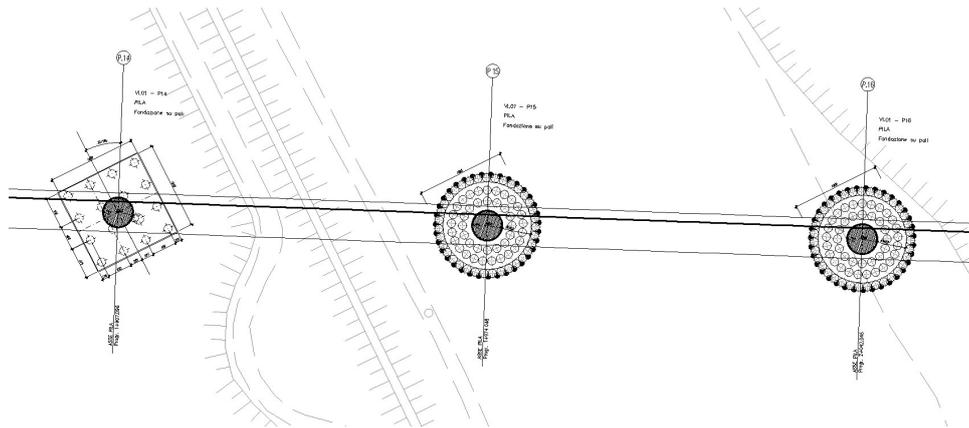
Pianta fondazioni – Campate a struttura reticolare in acciaio a via inferiore a doppio binario
